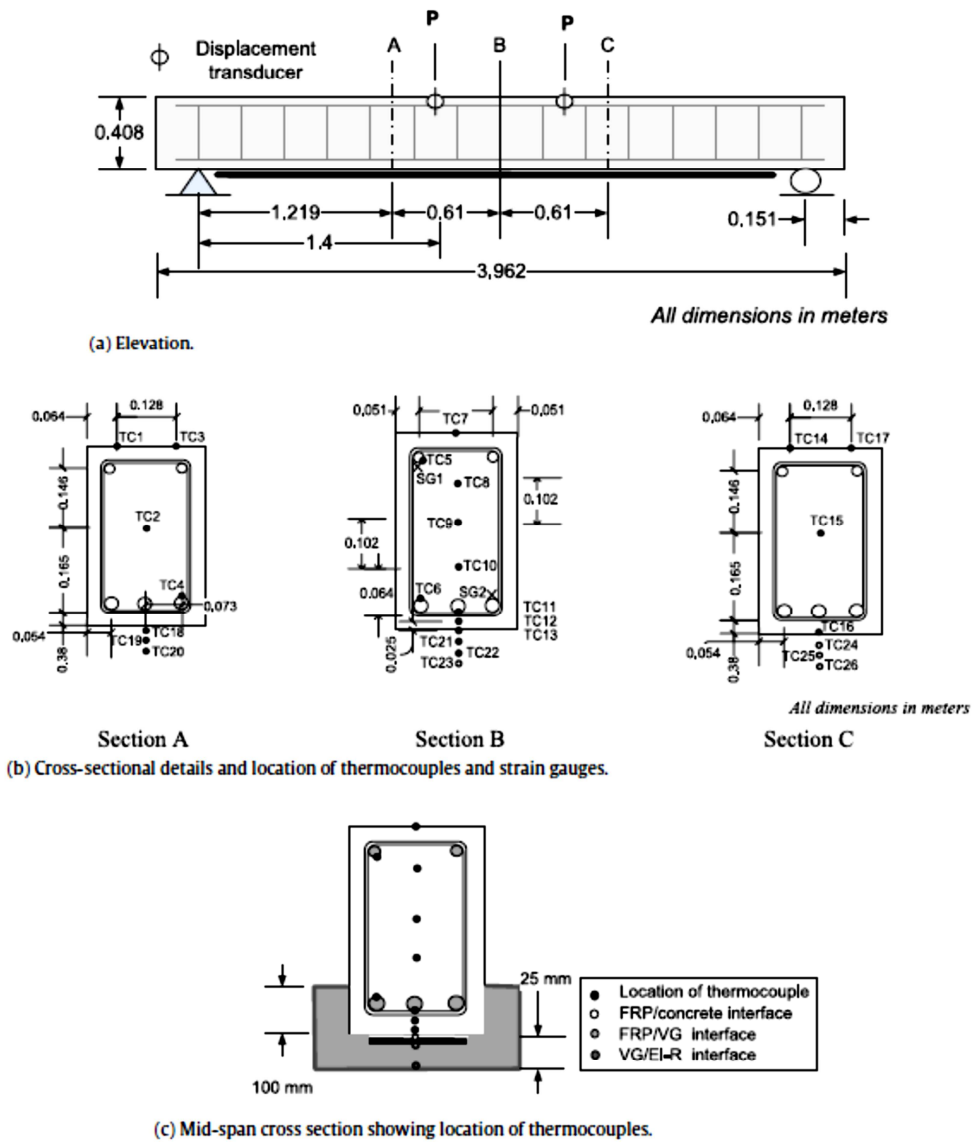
Prospetto e sezioni dettagliate dei provini.
